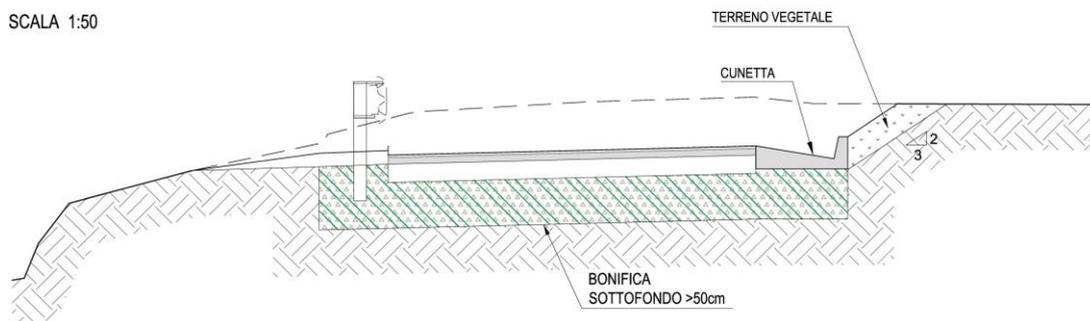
Sezione tipo del tratto con cunetta alla francese più trincea drenante o con solo cunetta
